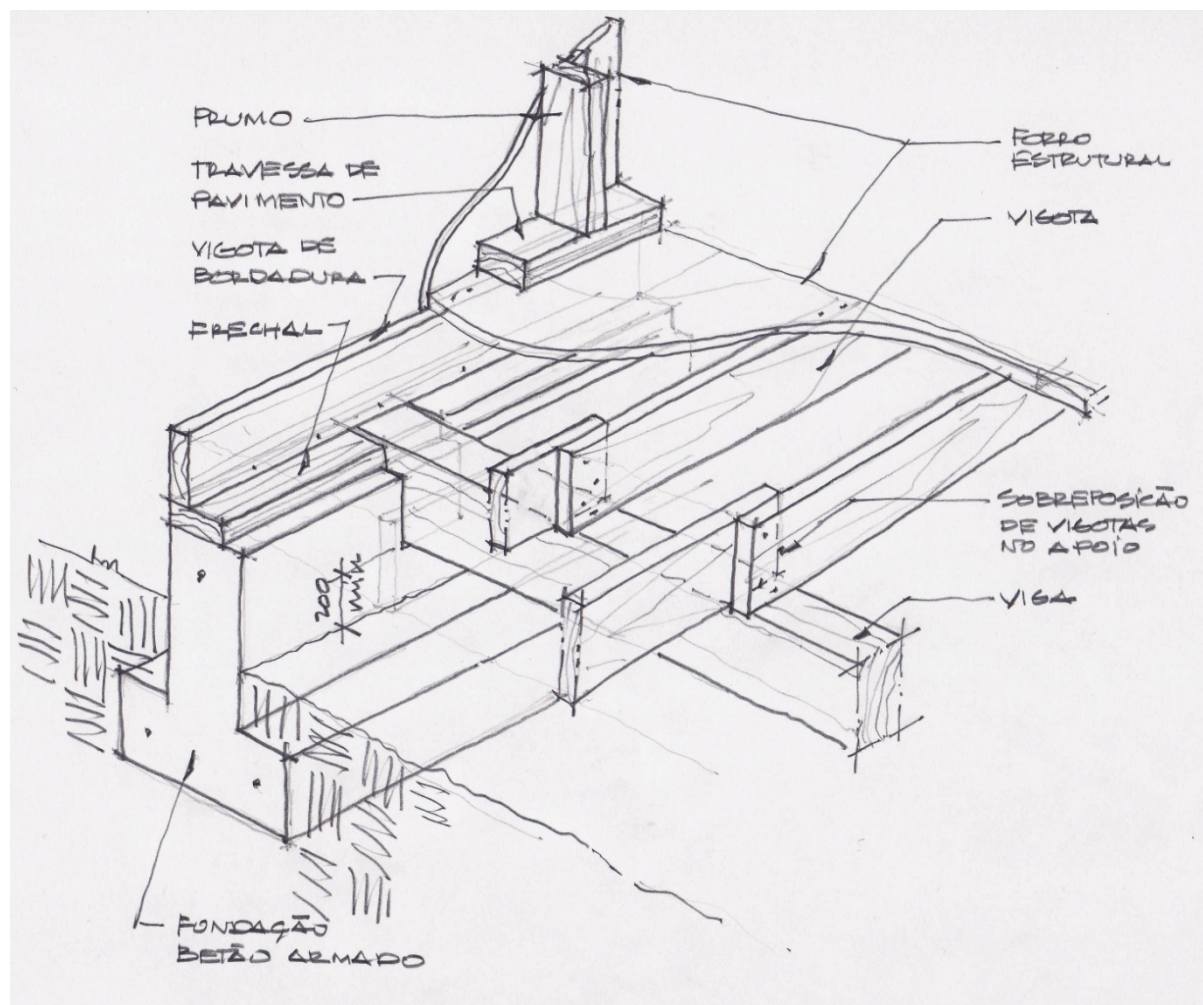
Protecção contra a deterioração da construção através dos afastamentos da madeira ao solo. (des. autor)
